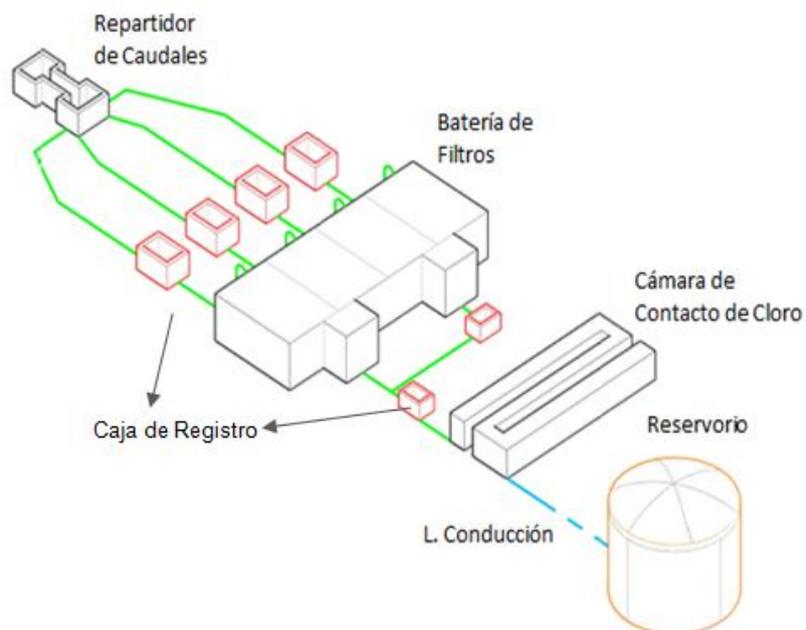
Esquema De La Planta De Tratamiento De Agua Potable
